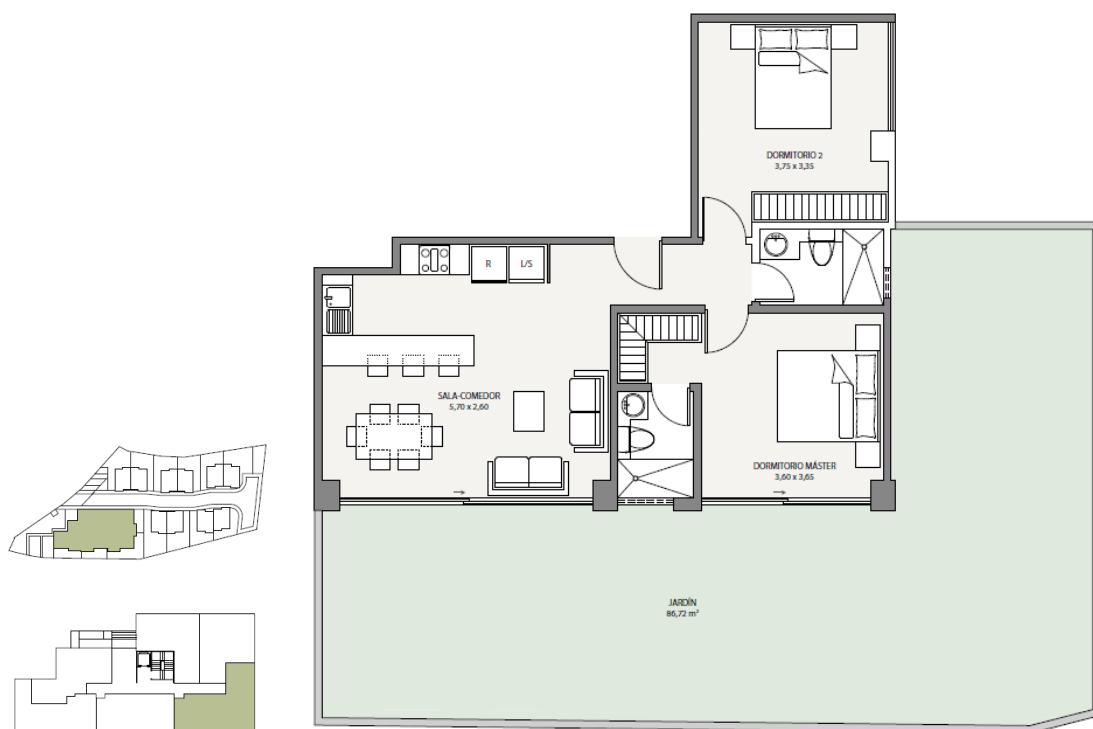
Planta departamento de dos dormitorios con jardín en planta baja
